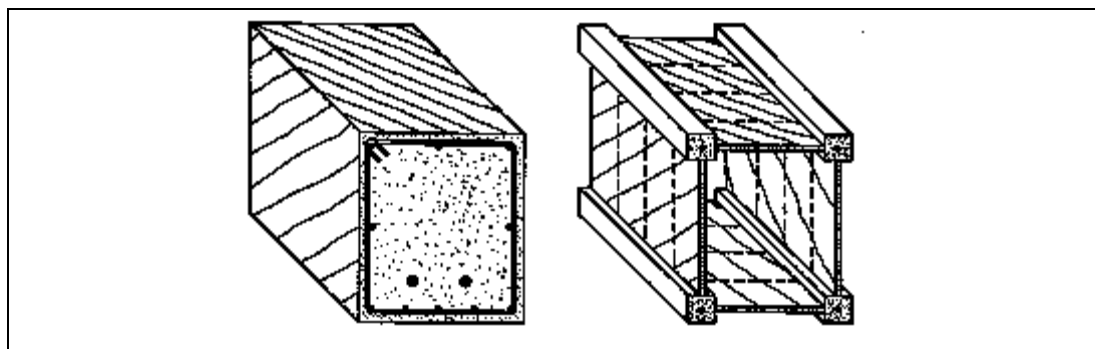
Modelo Corda-Painel para viga de concreto armado
